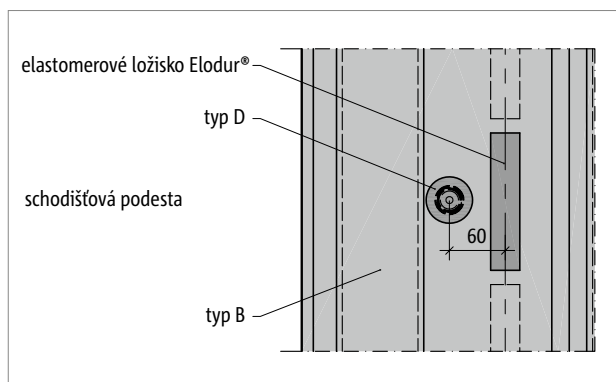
Schöck Tronsole® typ B + typ D: Alternativní zabudování
